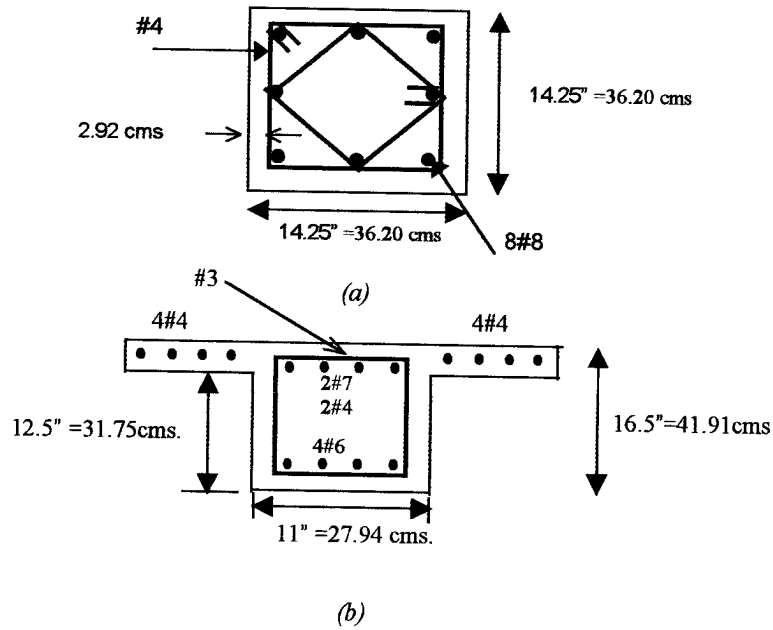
Detalles de la Sección de: (a) Columna (b) Viga del espécimen S2.[3]
